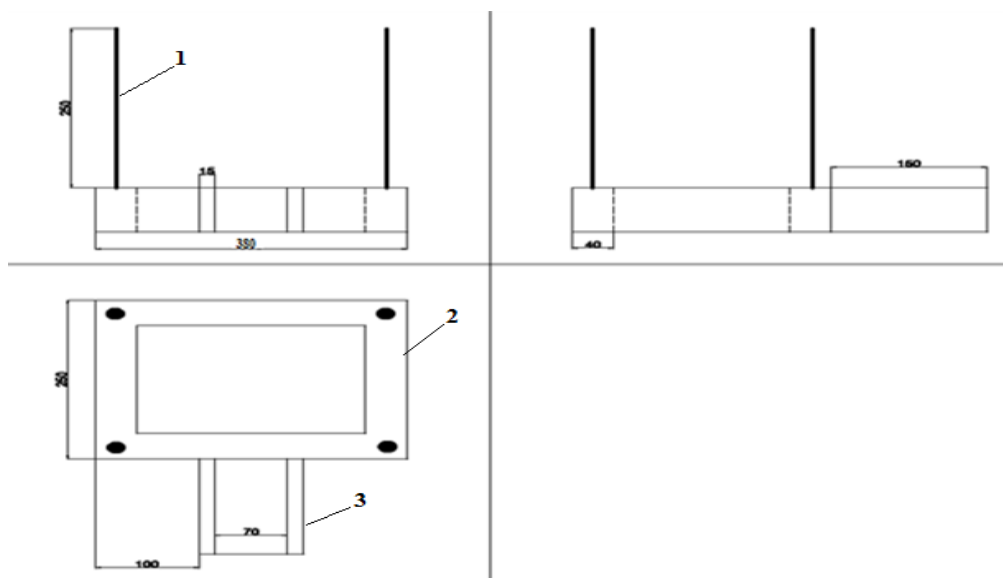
План подготовительной площадки 1-Стойки для навеса; 2-
